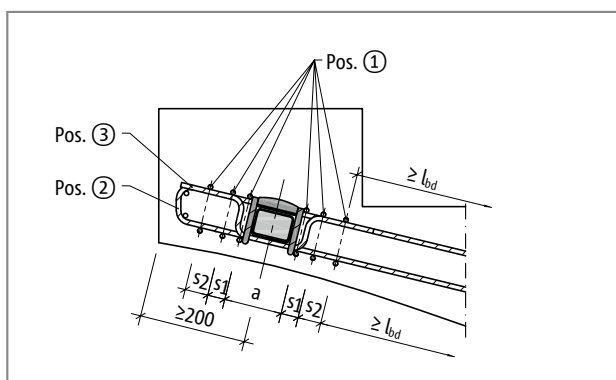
Schöck Tronsole® tipo Q, sezione "punto testa"
